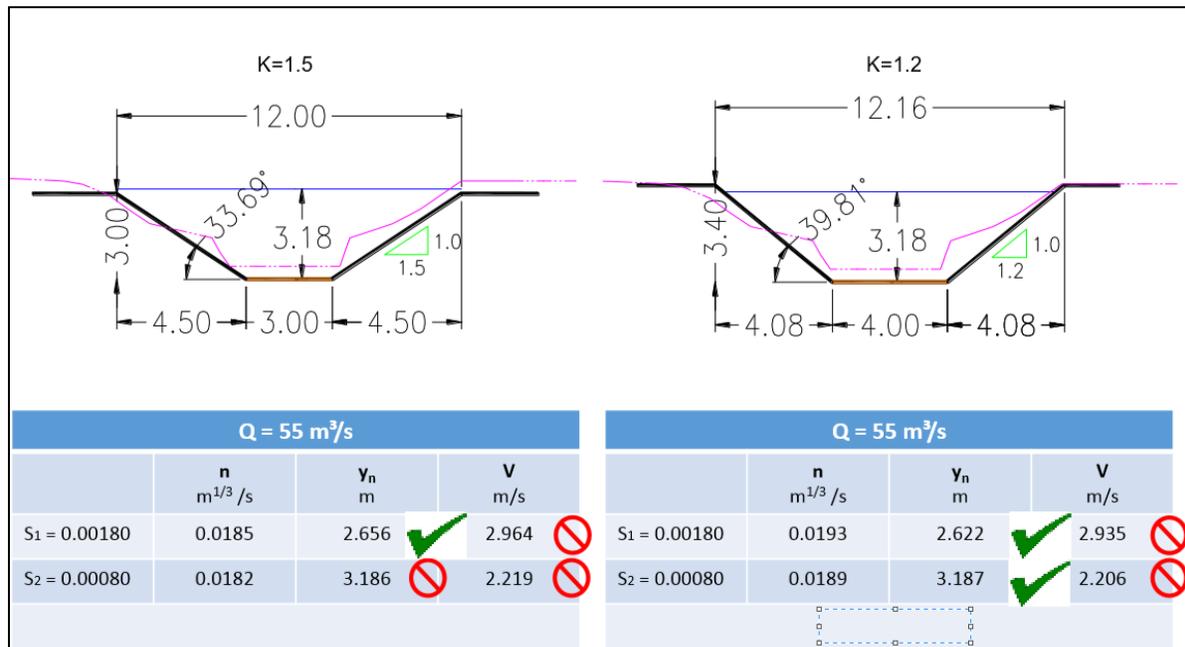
Opción 2 Sección de asfalto con fondo móvil (terreno natural).
